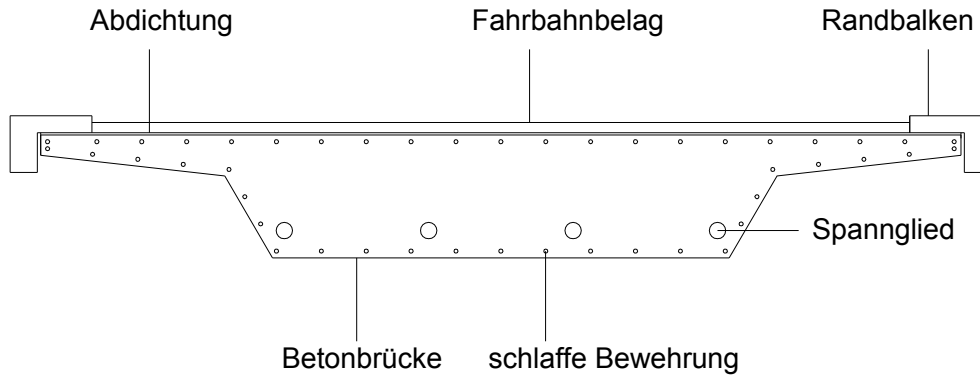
Querschnitt einer vorgespannten Betonbrücke mit Betonstahlbewehrung, Abdichtung und Fahrbahnbelag
